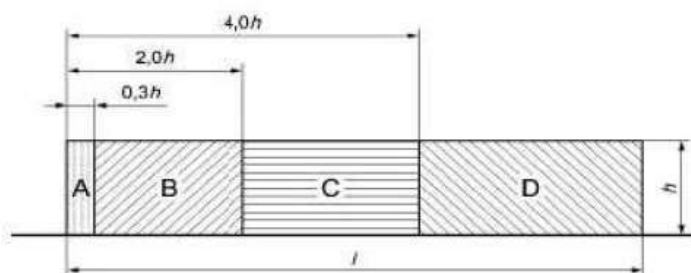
Distribución de zonas de zonas de presión. Fuente: proyecto.
